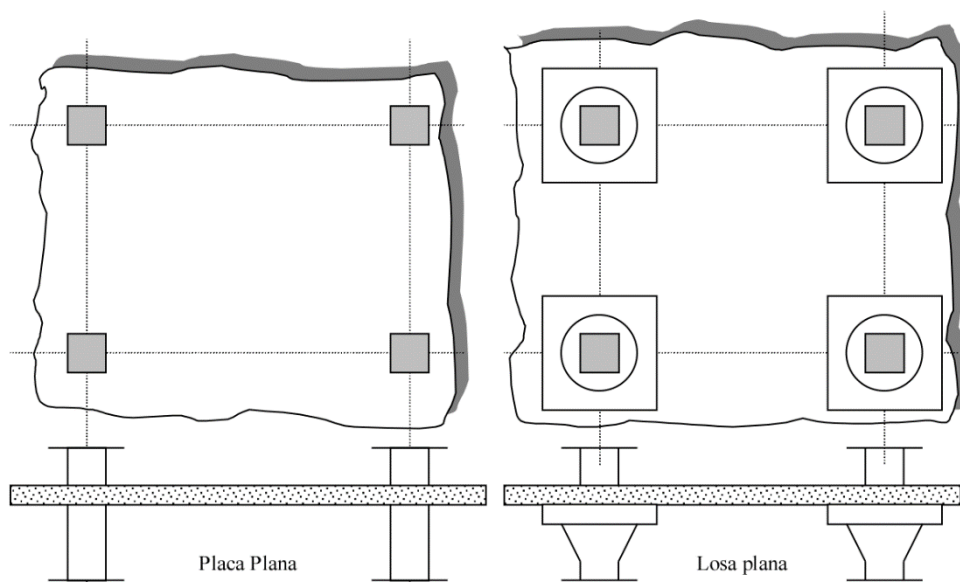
Sistemas de Placa Plana y Losa Plana.
